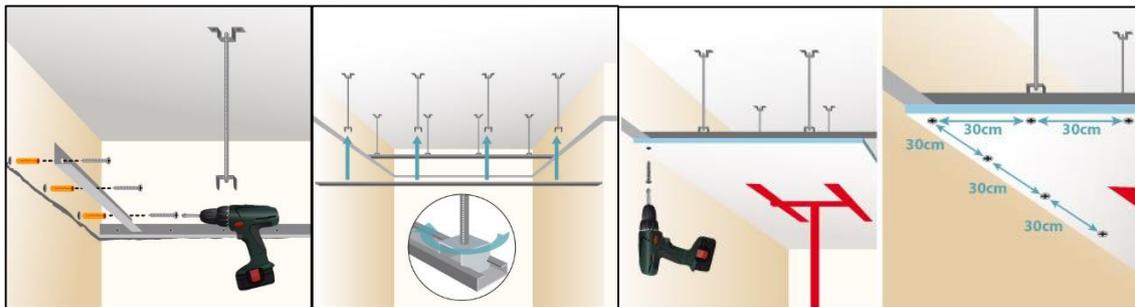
Faux plafonds (Source : plafond.ooreka.fr)
